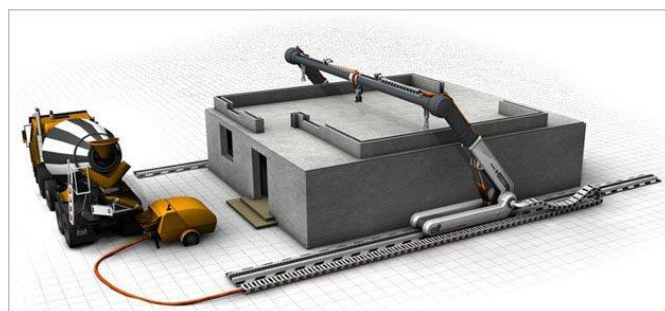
Construção de uma casa com robô de 3 dimensões (3D) [18]
